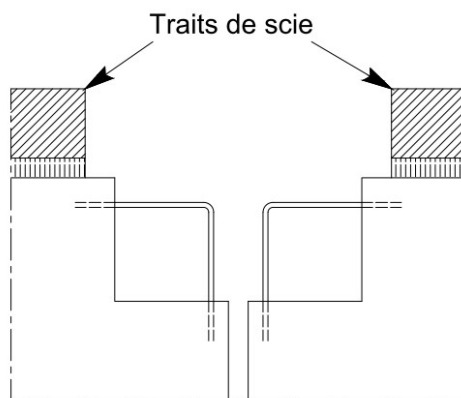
Sciage, découpage des couches de la chaussée et dégagement de la feuillure
